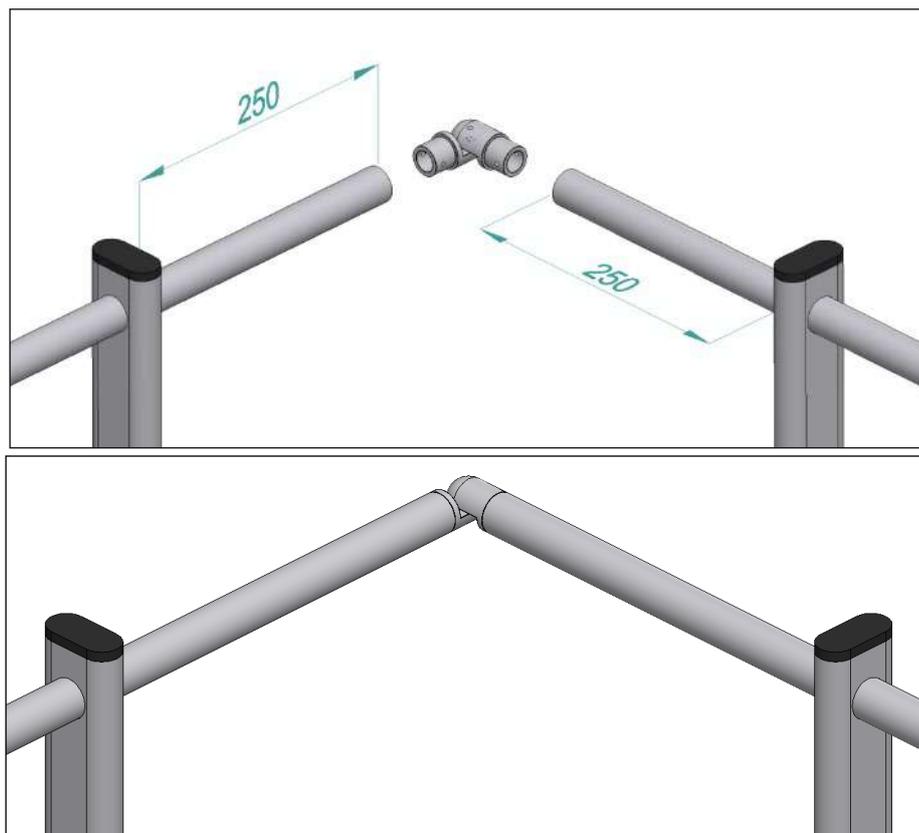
Posicionamiento y fijación del manguito articulado entre barandales en los ángulos de la cubierta.
